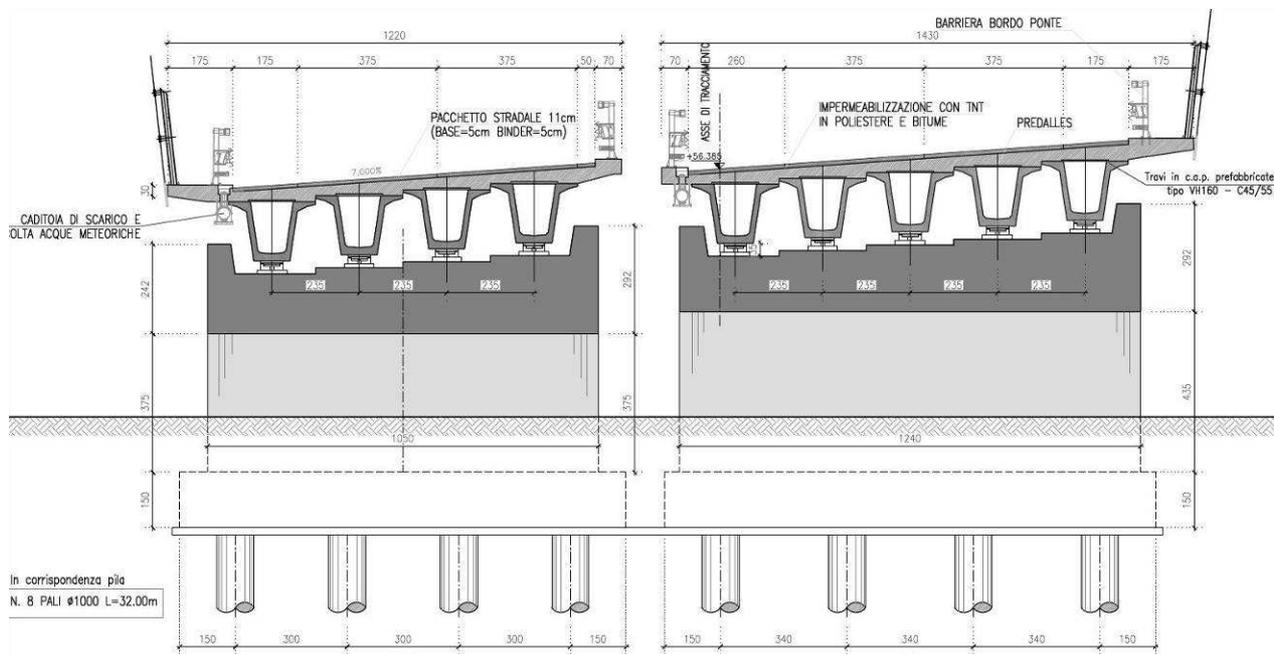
SEZIONE TIPO CAMPATA IN C.A.P. VIADOTTO CROSTOLO (ESTRATTO DALL'ELABORATO T00VI01STRDI01A)
